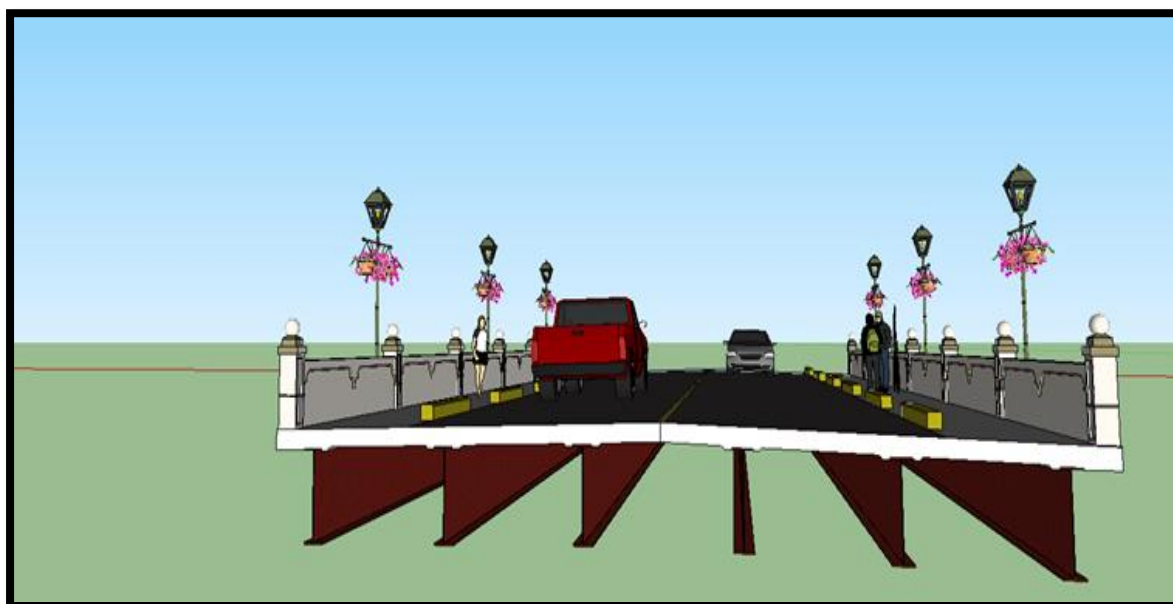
Corte frontal de Superestructura de puente Guadalupe, observación de bordillos y poste de concreto
